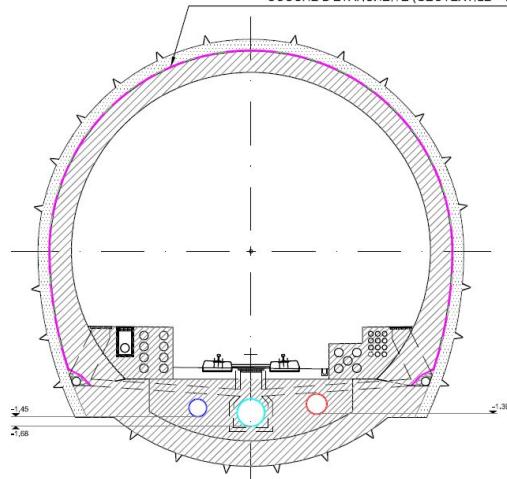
Impermeabilizzazione di tipo 1/1a per scavo tradizionale
